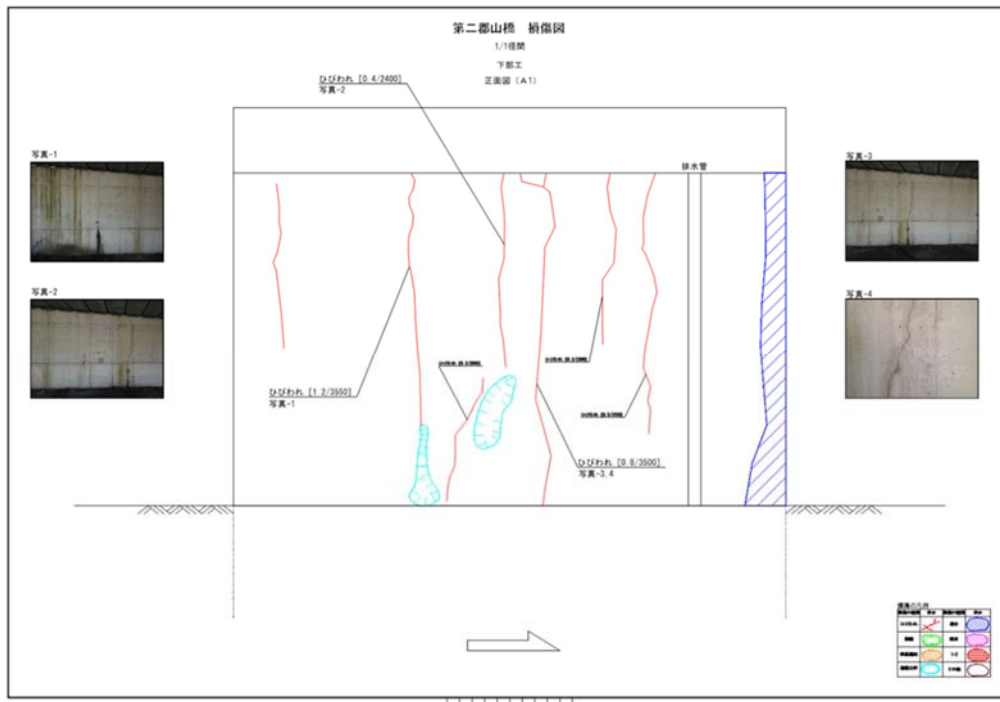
対象橋梁橋台のひび割れ損傷図
